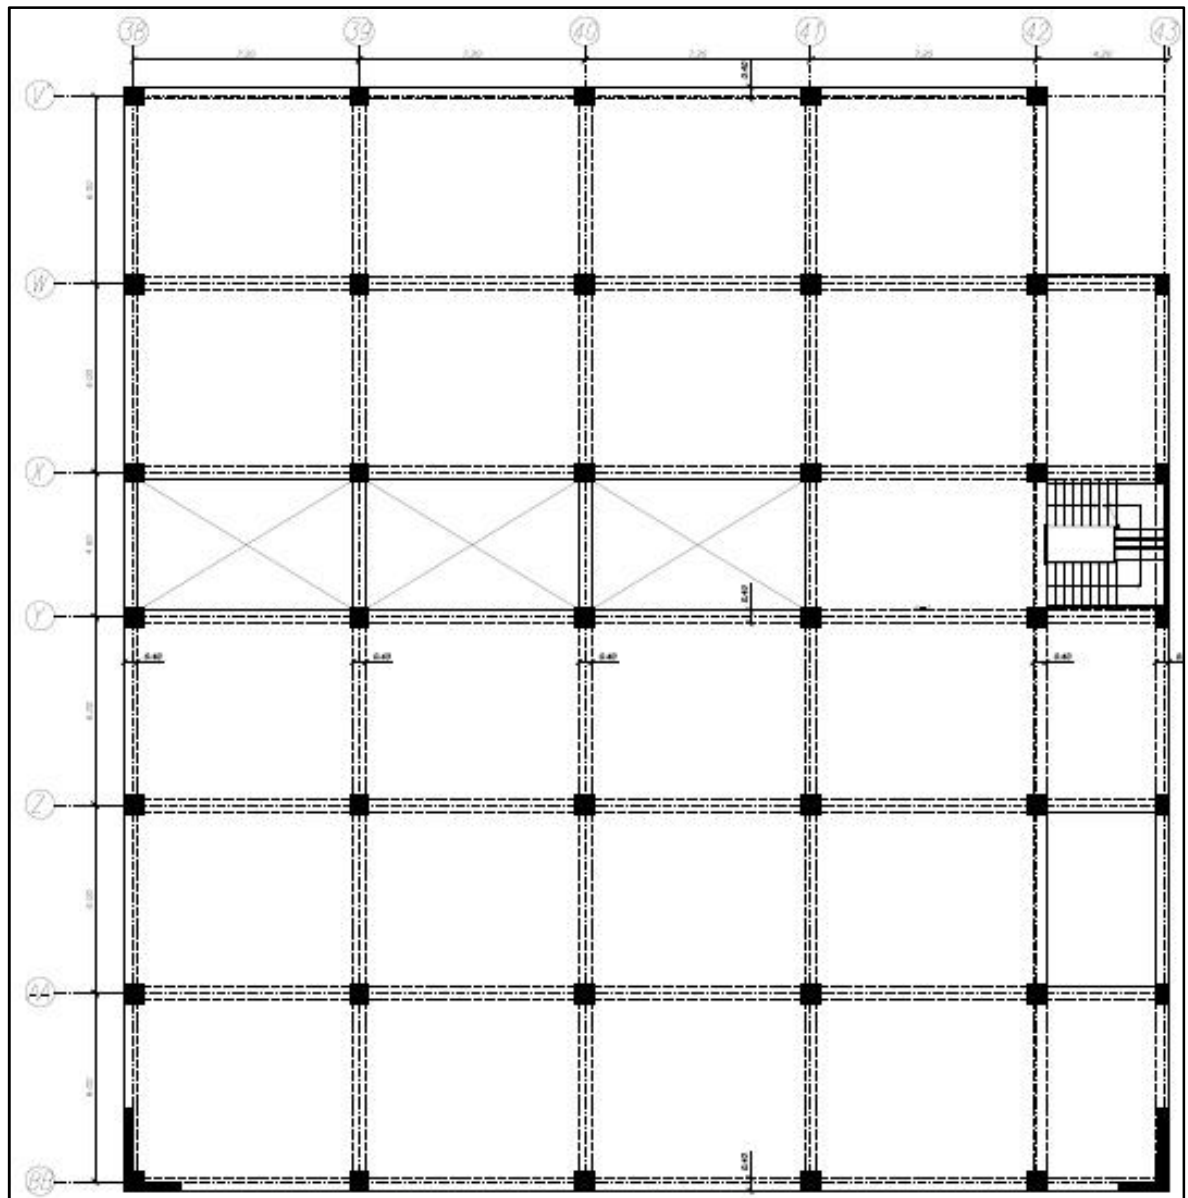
Planta estructural N+7.92, Consulta Externa II
